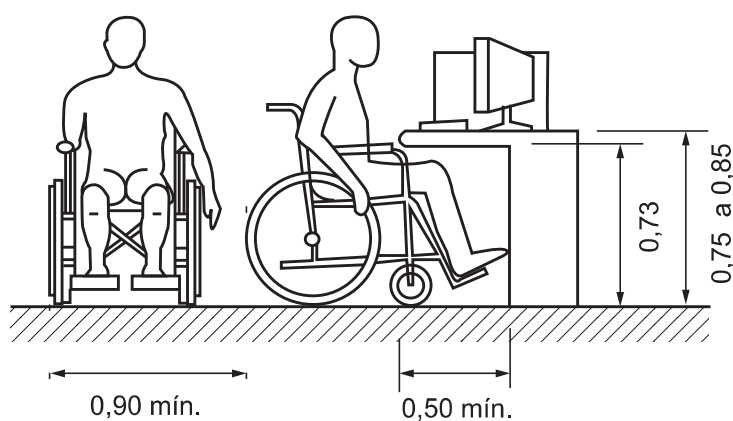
Terminais de consulta – Exemplo – Vista lateral
